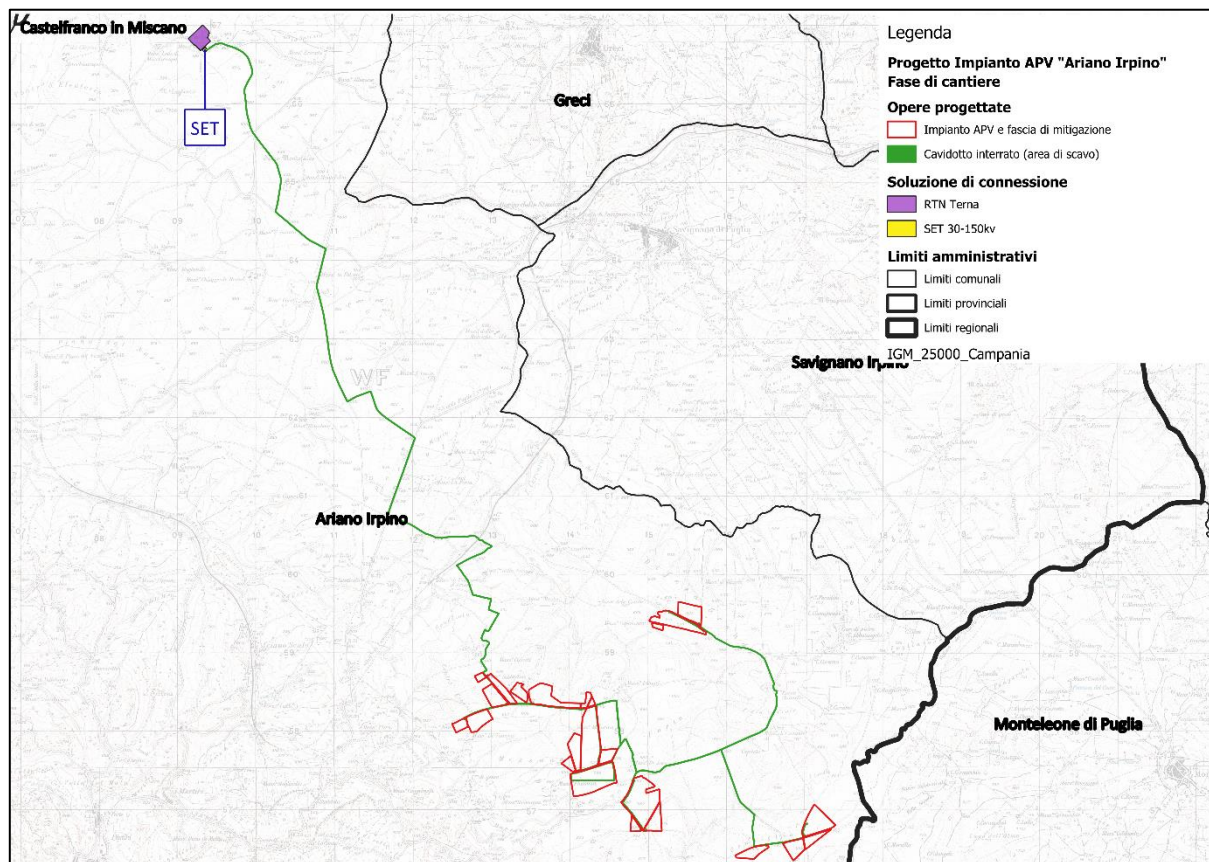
planimetria riportante le aree di intervento per ciascun elemento progettuale (impianto fotovoltaico, opere di connessione, fascia di mitigazione, sottostazione elettrica e opere connesse) in fase di cantierizzazione
